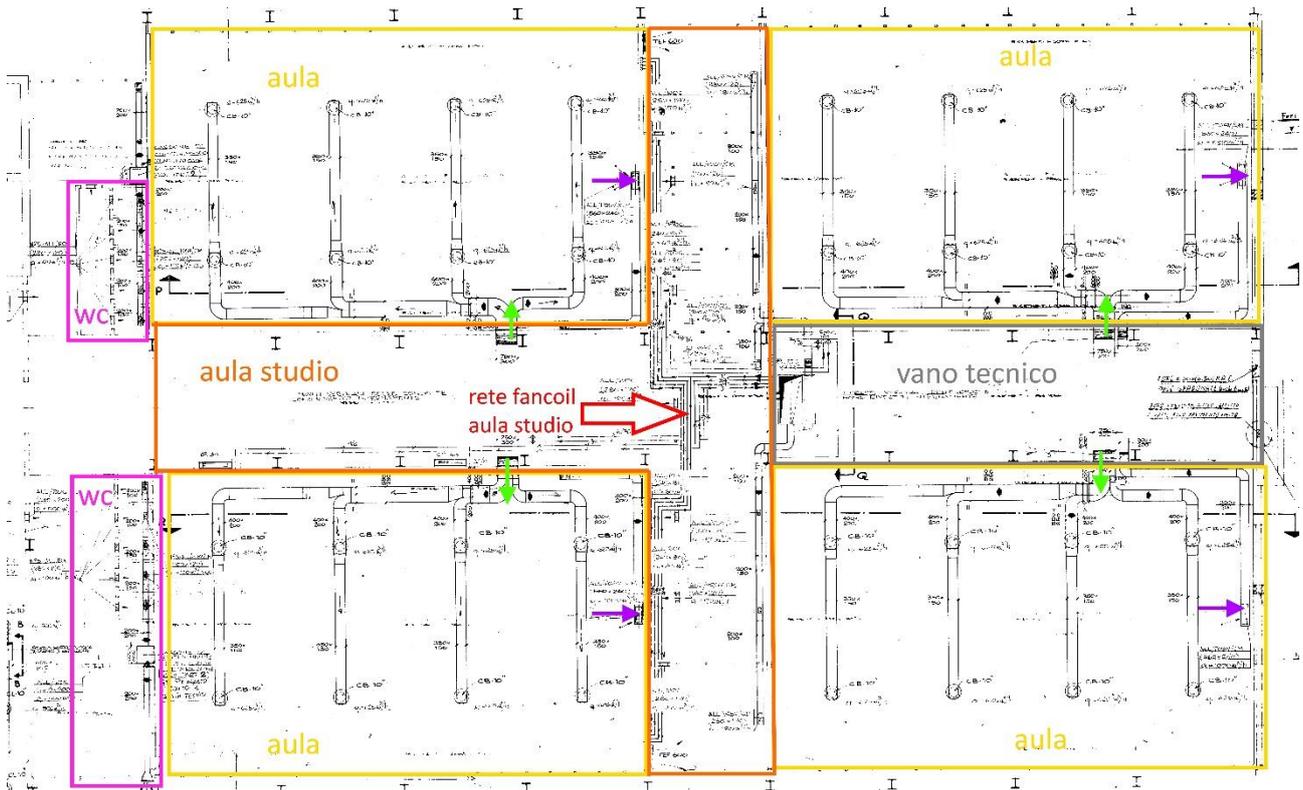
Distribuzione delle condotte dell' impianto aeraulico delle 4 aule. La sezione al piano rialzato mostra inoltre la rete del caldo che alimenta i fancoil dell' aula studio.
